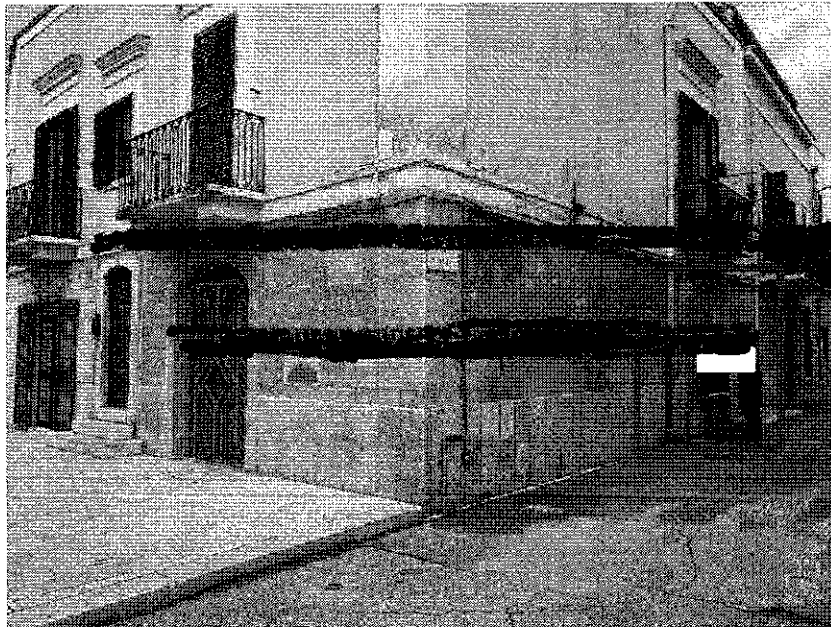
ingresso locale piano terra – Via Staffa n. 1
